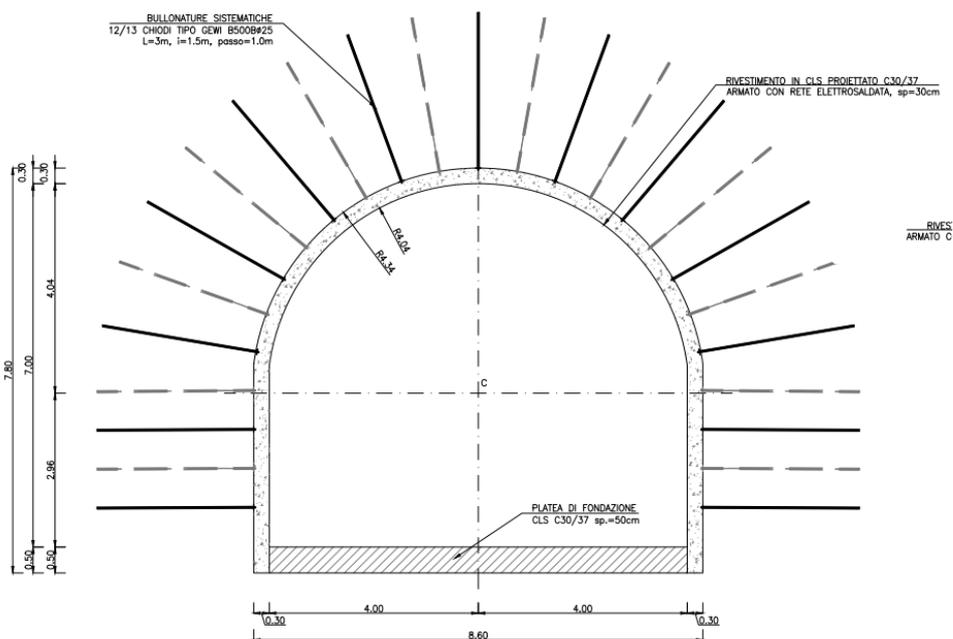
Sezione tipo della galleria d'accesso al pozzo piezometrico
